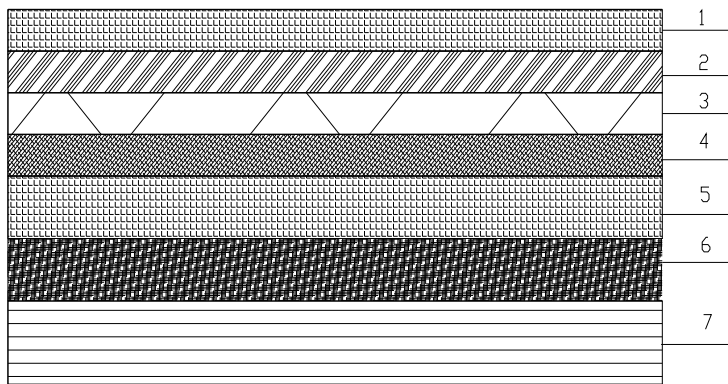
b. Coupe du plancher de la cage d'escalier.
